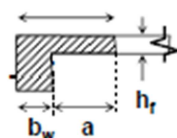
Viga T, ancho colaborante o efectivo [23].
